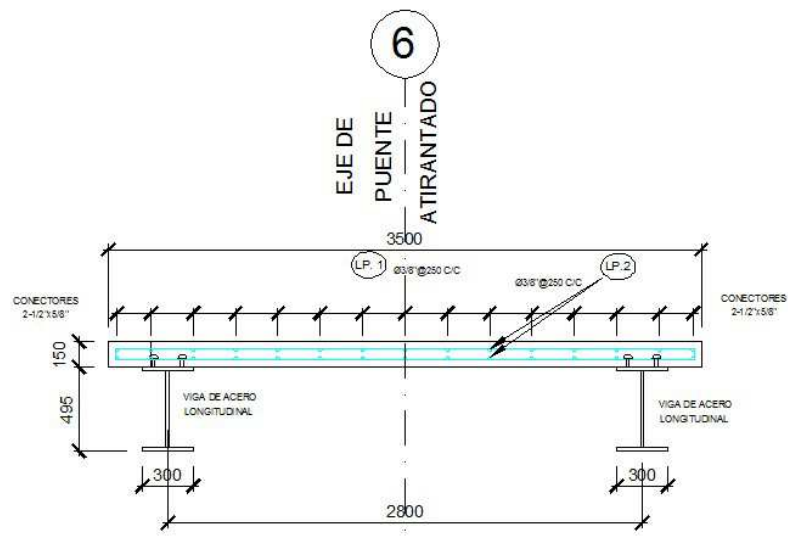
Sección transversal de puente en tramo atirantado.
